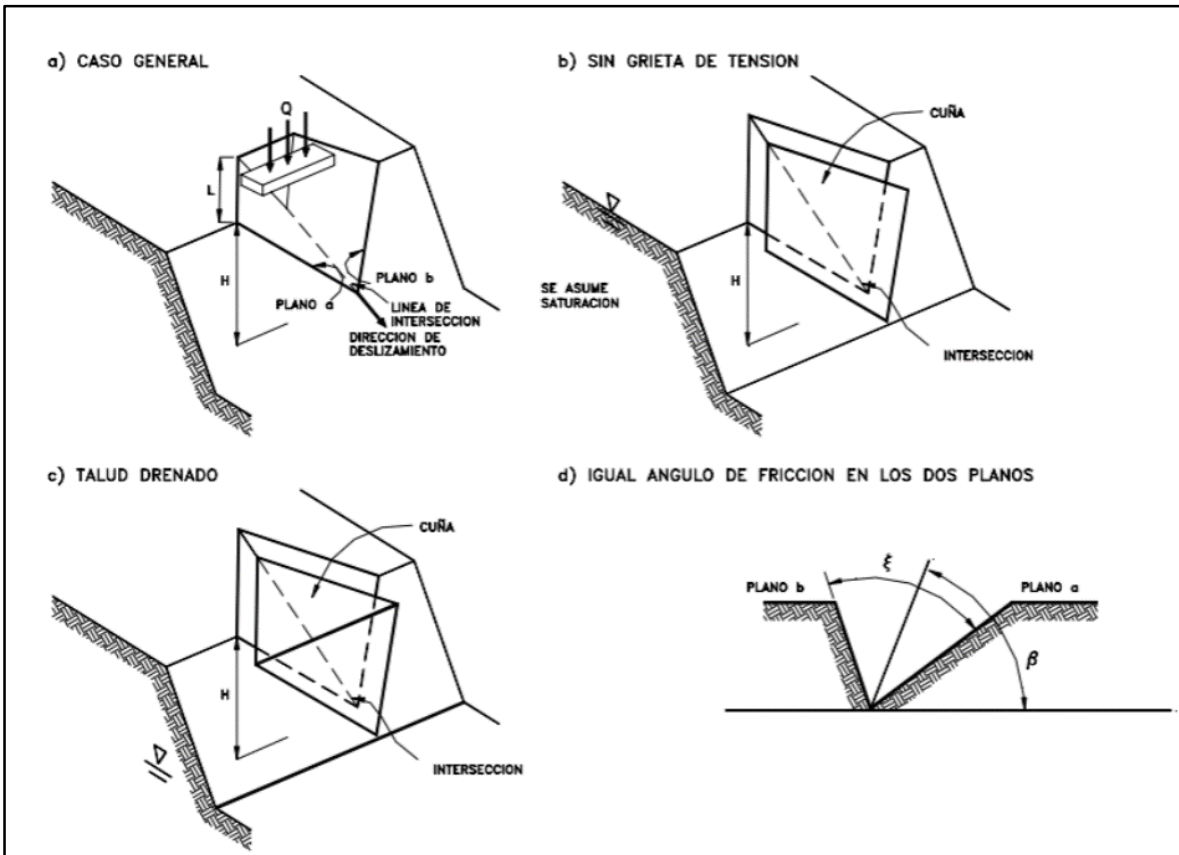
Esquema general de la falla en cuñas. a) Caso general; b) Sin grietas de tensión; c) Talud en condición drenada; d) Cuña con igual ángulo de fricción en los dos planos.
